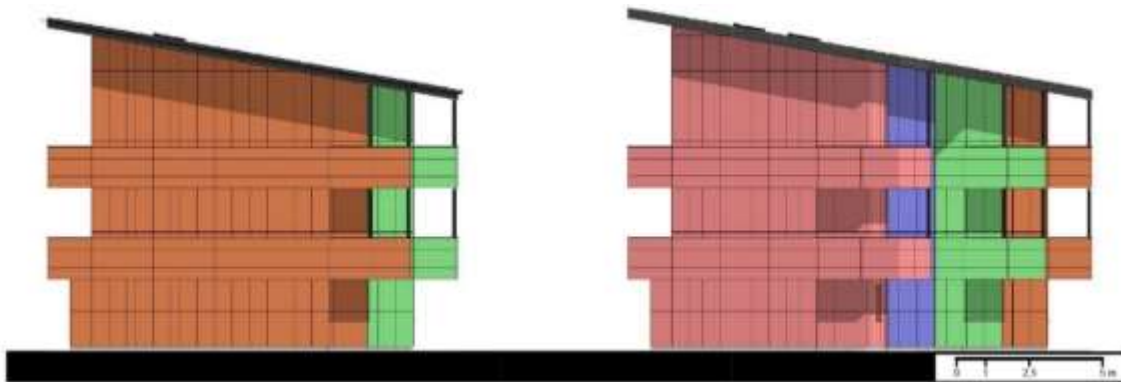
Prospetti ovest del Complesso 1 e del Complesso 2 rispettivamente. [Fonte: elaborazione dell'autore]
